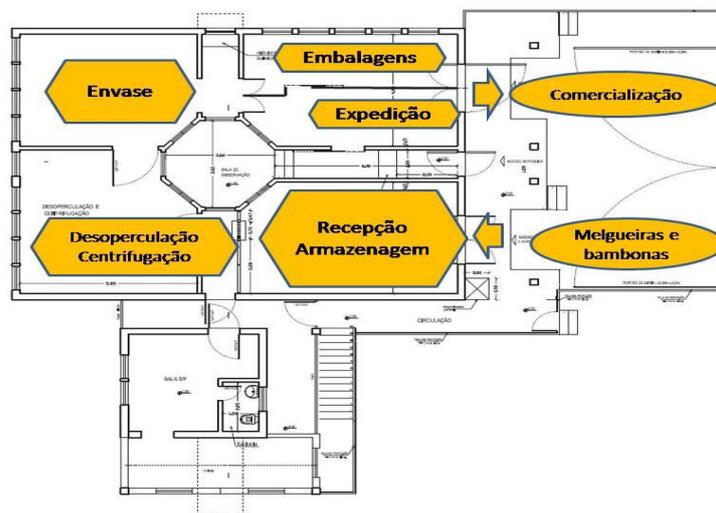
Planta baixa do Entreposto Fonte: AGA
